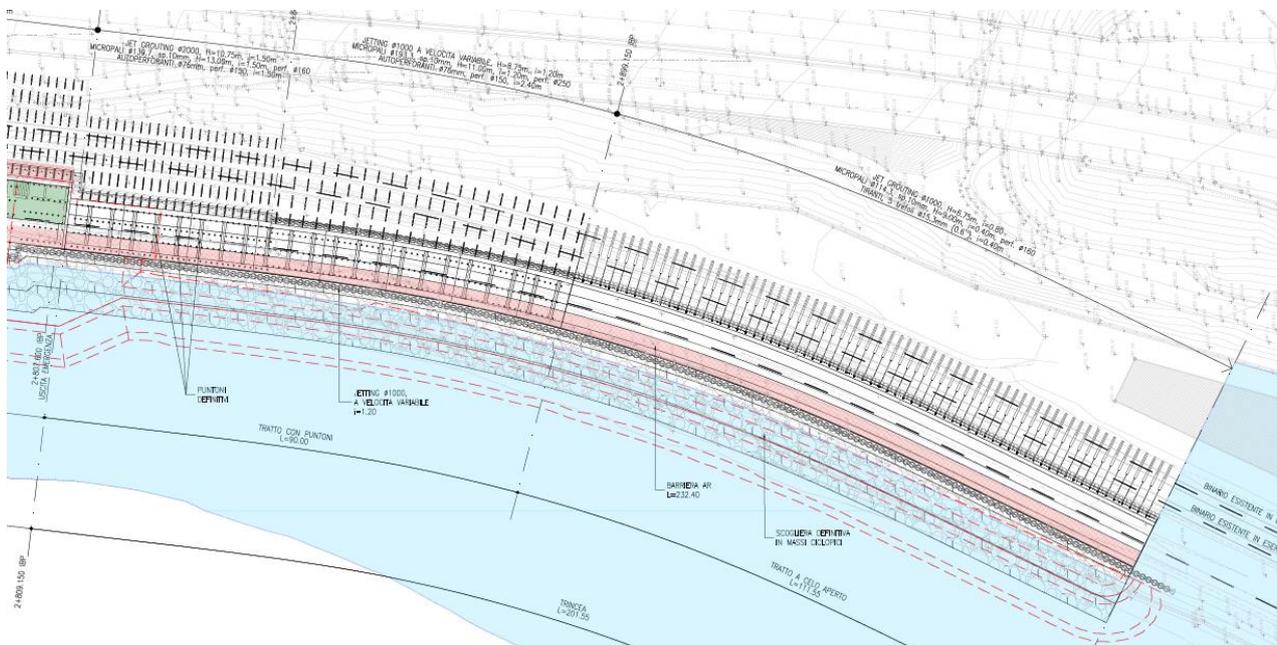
Planimetria dell'imbocco (Parte 2/2)
